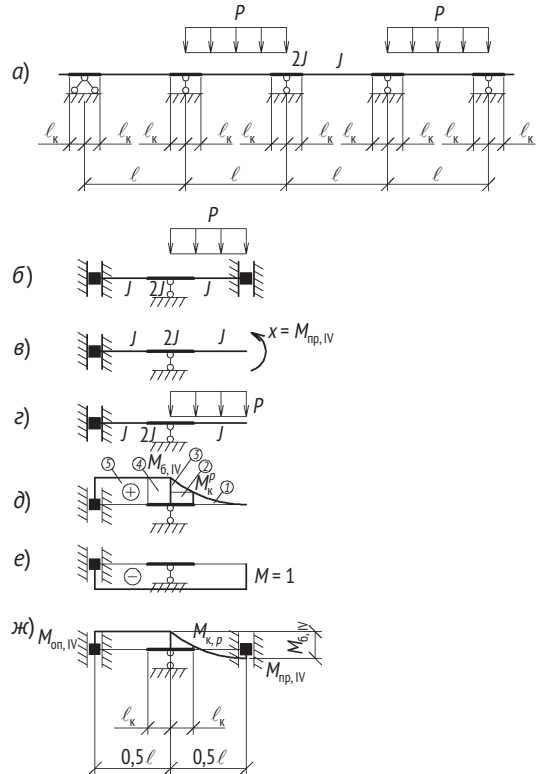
Загрузка балки прерывистой временной нагрузкой через пролет а – расчетная схема; б – преобразование расчетной схемы; в – эквивалентная система метода сил; г – основная система метода сил; д – грузовая эпюра моментов; е – единичная эпюра моментов; ж – окончательная эпюра моментов
